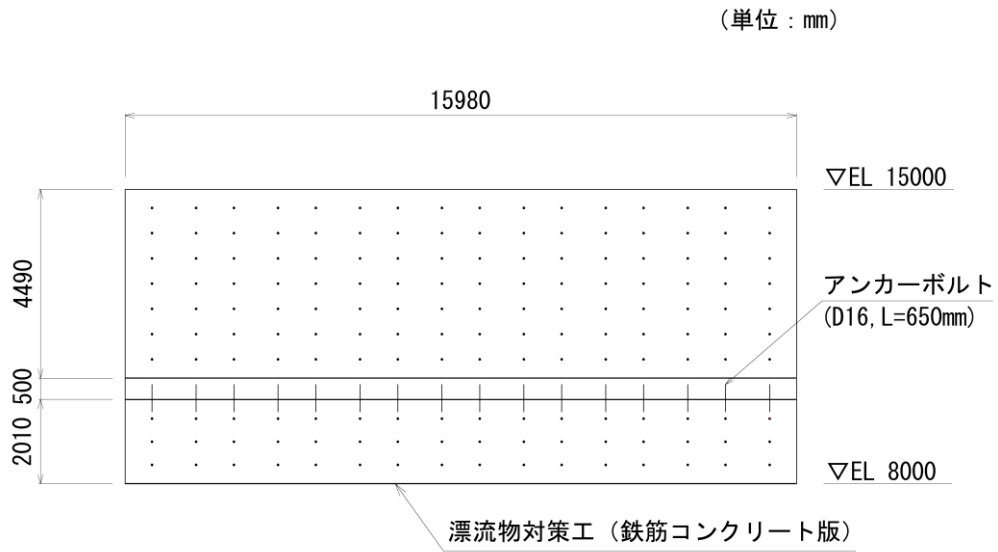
(1) 漂流物対策工 (鉄筋コンクリート版) のアンカーボルト配置図 (正面図)
